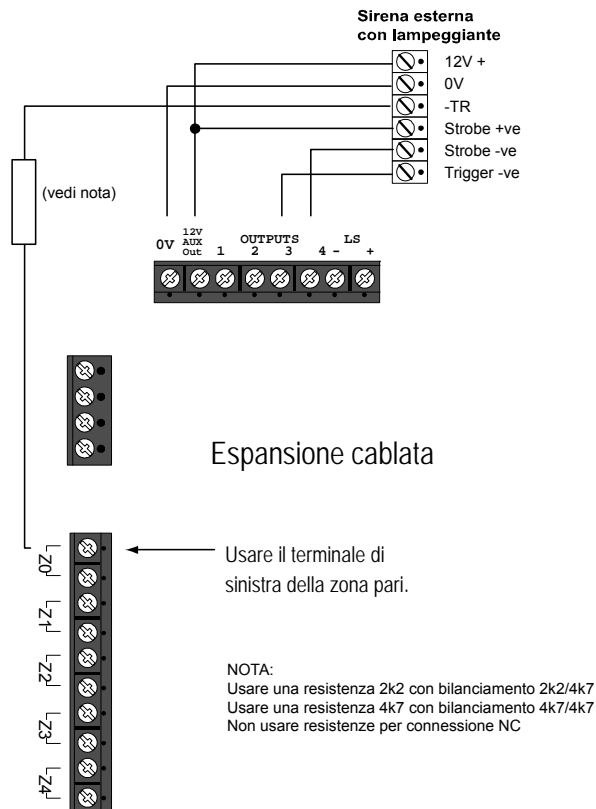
Collegamenti –TR da Sirena Esterna ad una Zona sull'Espansione.
